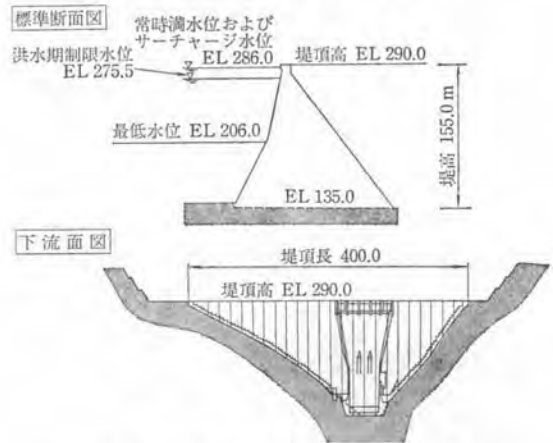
宮ヶ瀬ダムの標準断面図と下流面図
